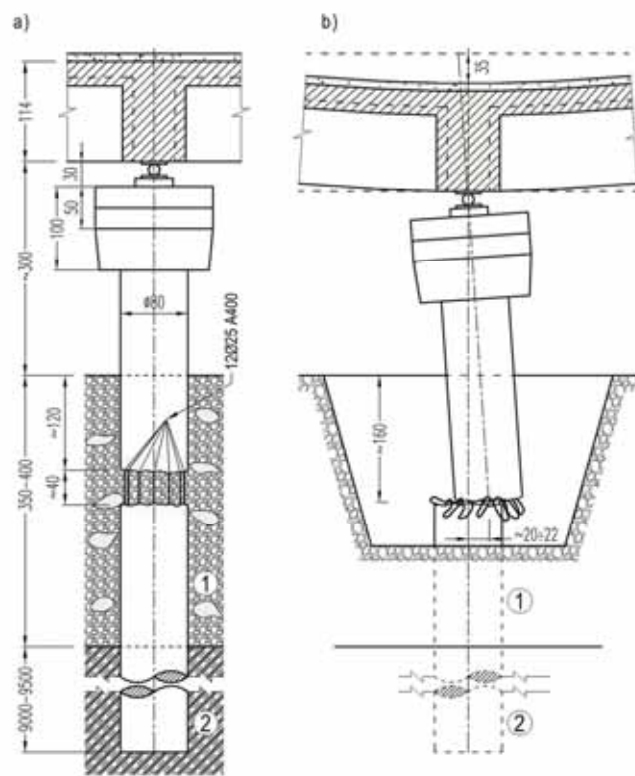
Ймовірний дефект бетонування стовпа опори (а) та її стан після відкопування до зони руйнування (б)
